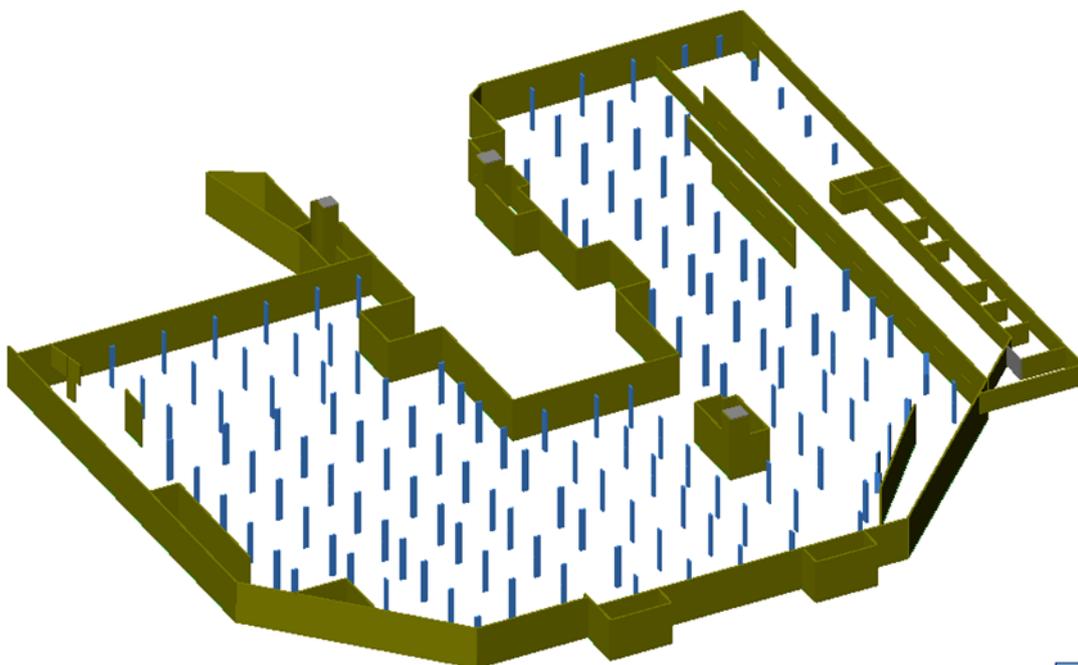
Vista 3D- Schema Muri – Schema Pilastri
